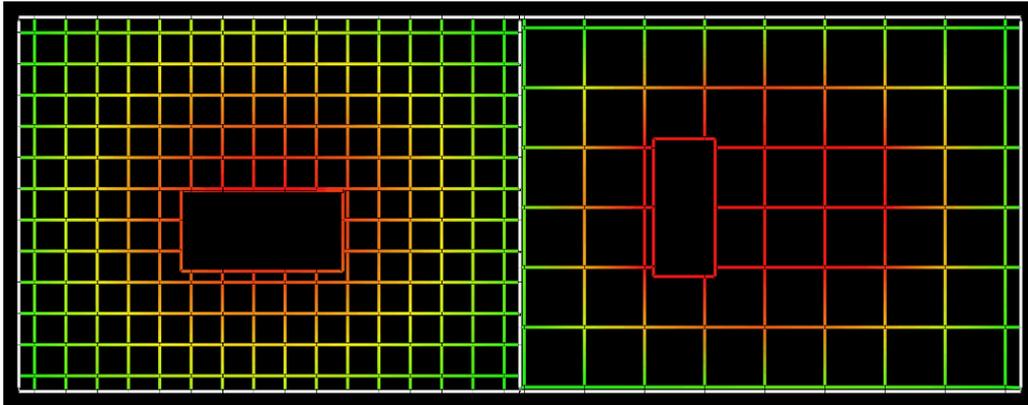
Modelo de grelhas em laje em regiões próximas a aberturas (FONTE: site do Alto QI Eberick)
